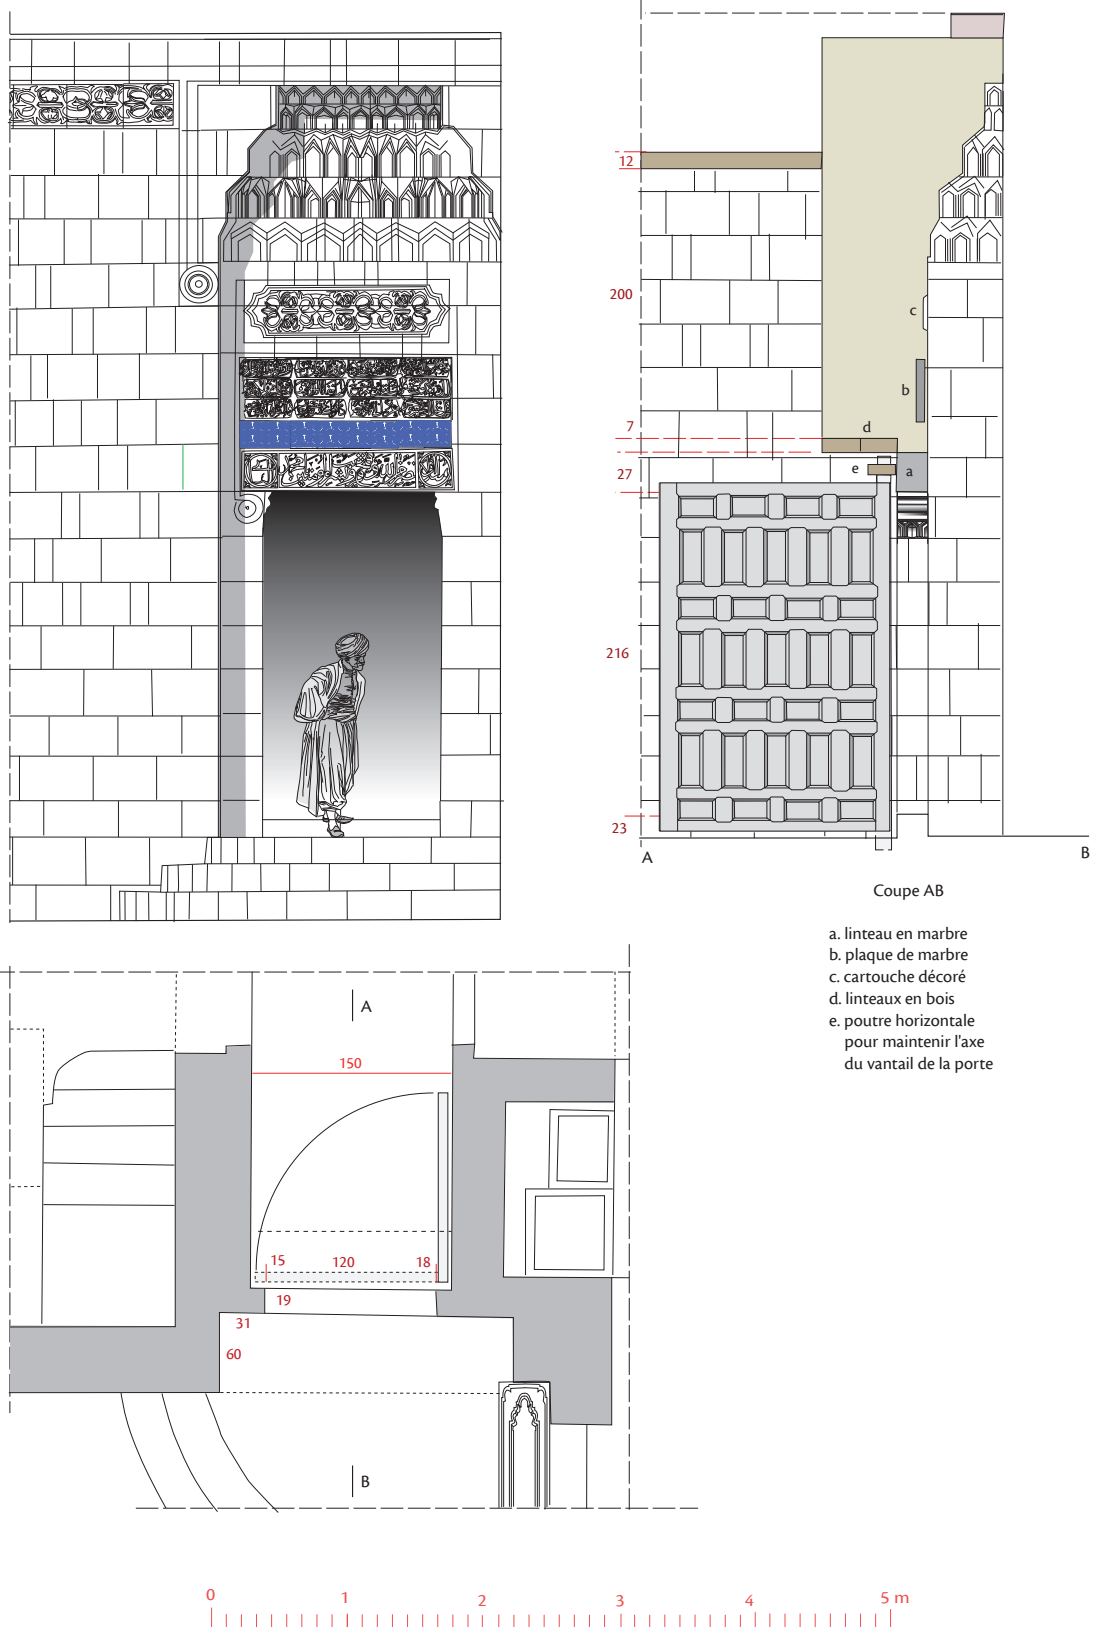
Plan, coupe et élévation de la porte d'entrée du bâtiment A.
